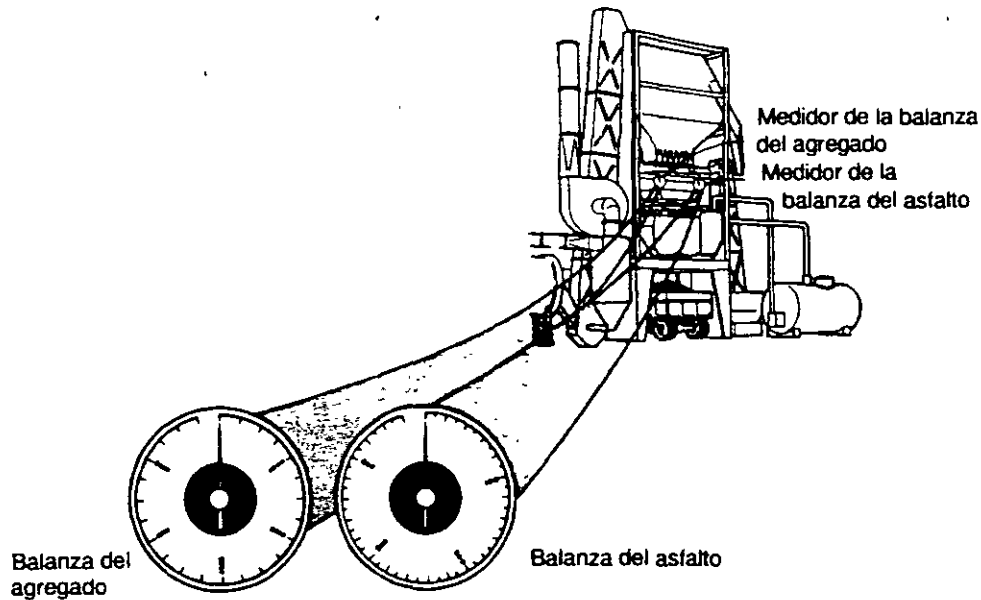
Disposición Típica de las Básculas de la Planta.
